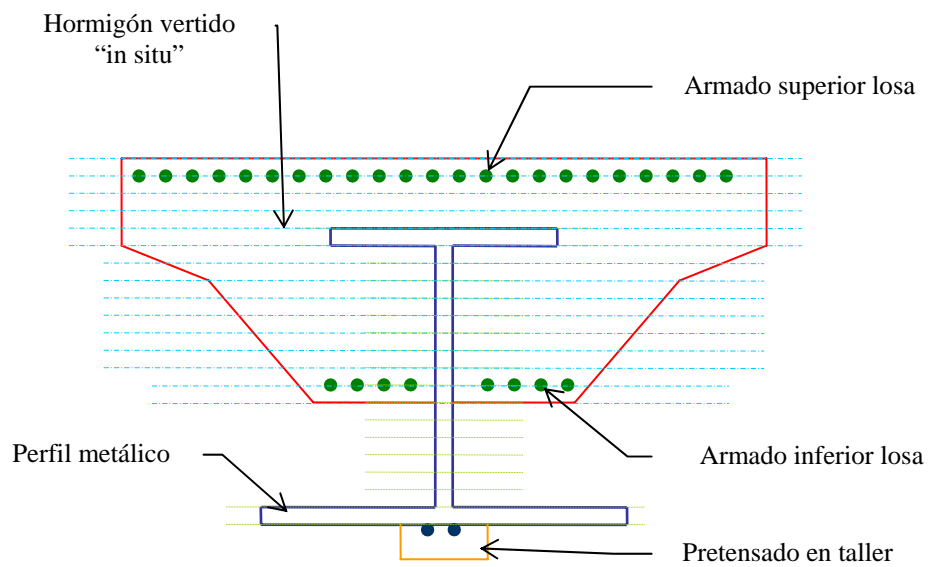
Ejemplo de discretización de una sección mixta hormigón – acero pretensada
